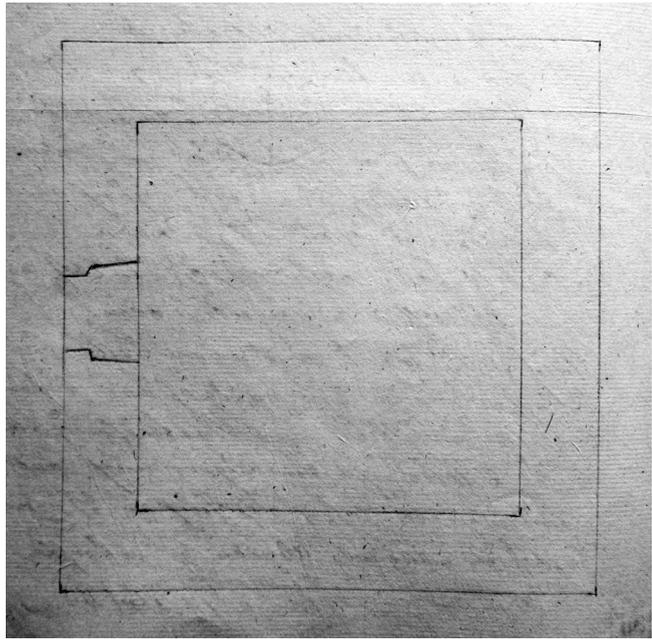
Grundriss zum geplanten Schmelzofen von Demygen [ISG, Neunerkollegium, Nr. 1920]
